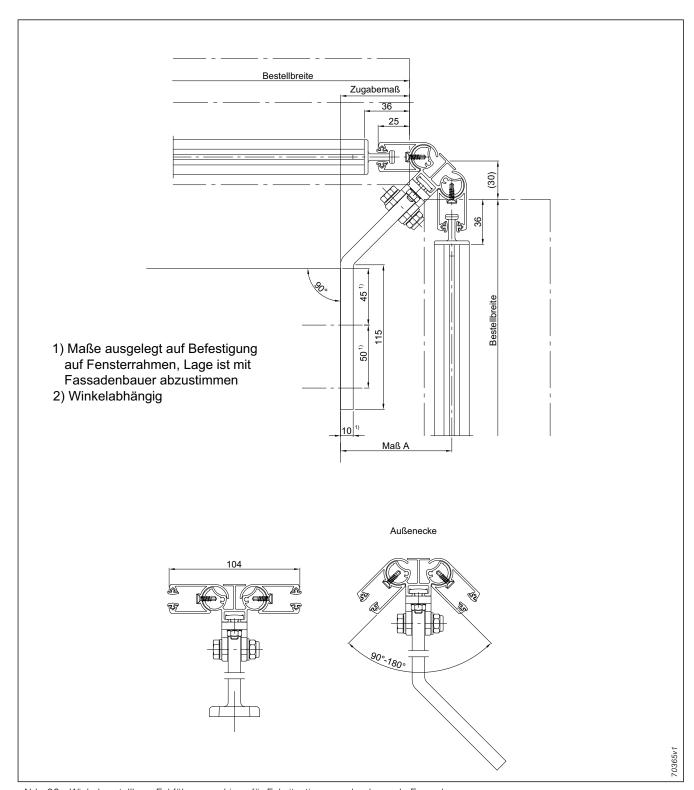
Winkelverstellbare Eckführungsschiene für Ecksituationen und polygonale Fassaden
